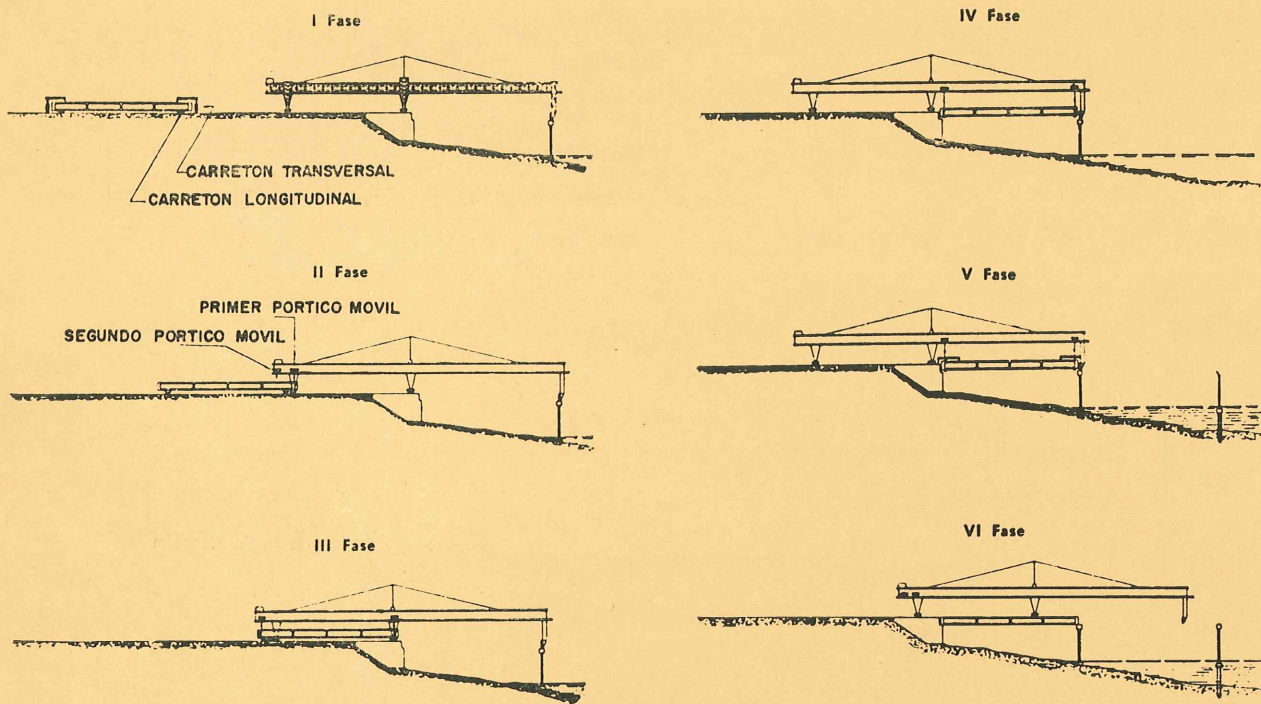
Las diversas fases del transporte y de la puesta en obra de las vigas prefabricadas
